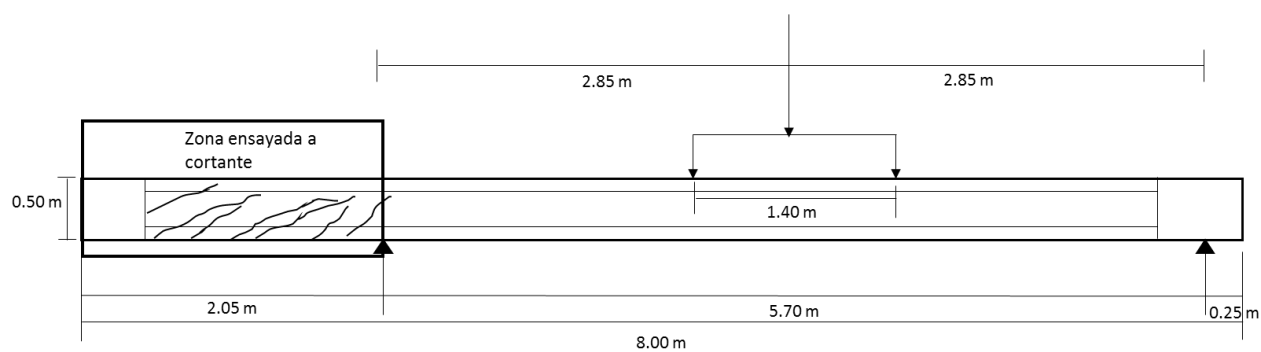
Esquema del ensayo a flexión de la viga I-3.
